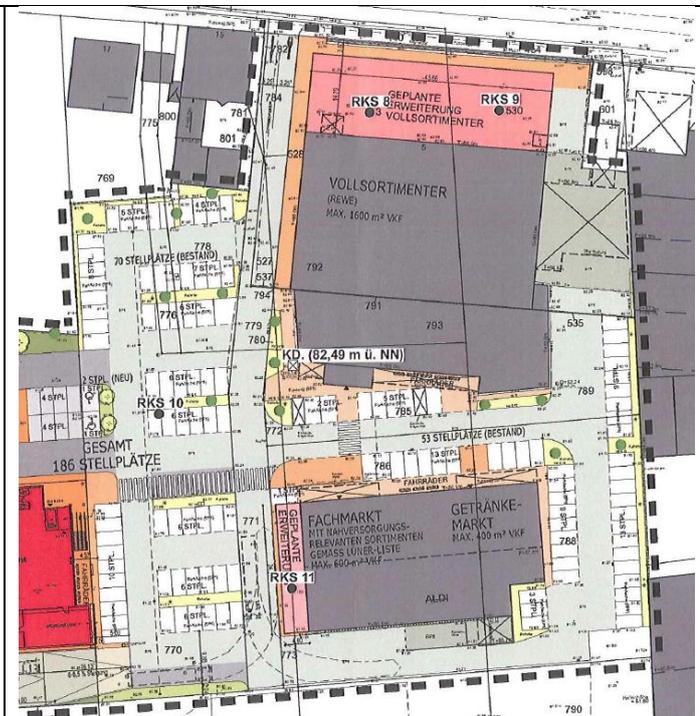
Lageplan mit eingetragenen Bodenaufschlusspunkten
